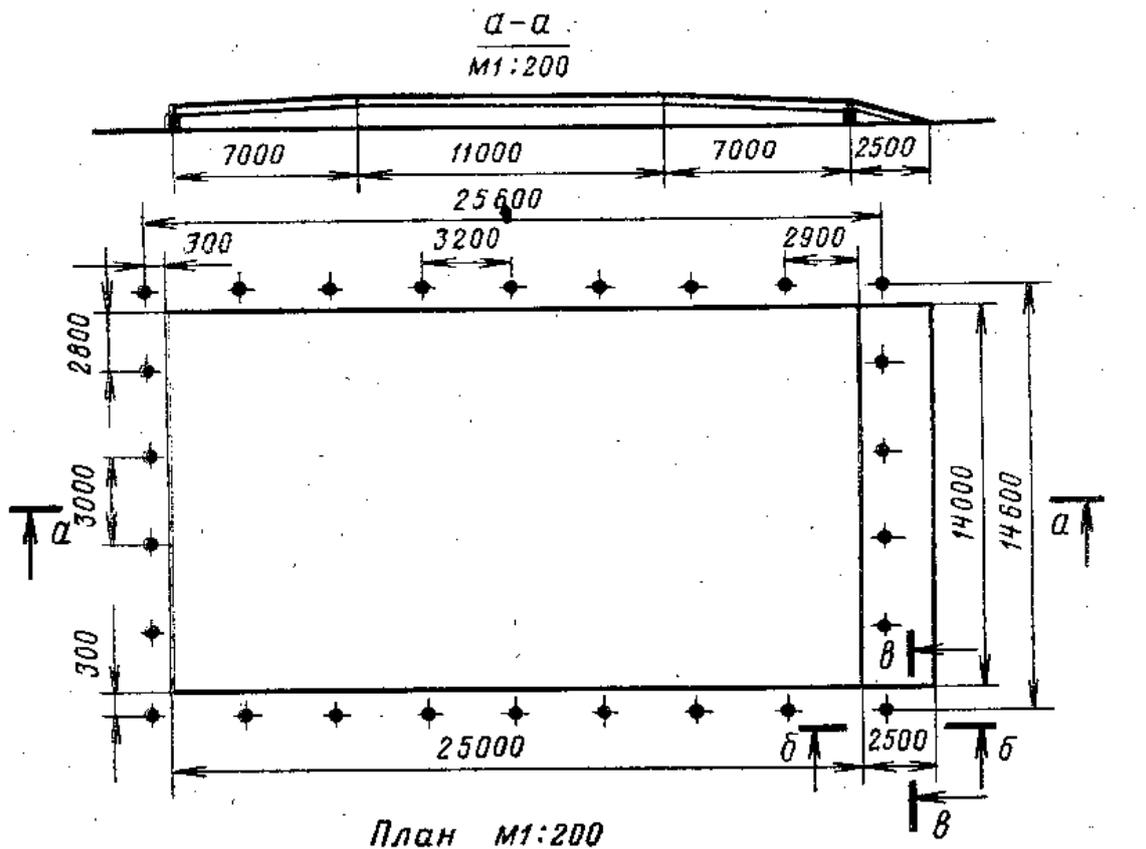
Схема площадки для бунтования хлопка-сырца.
